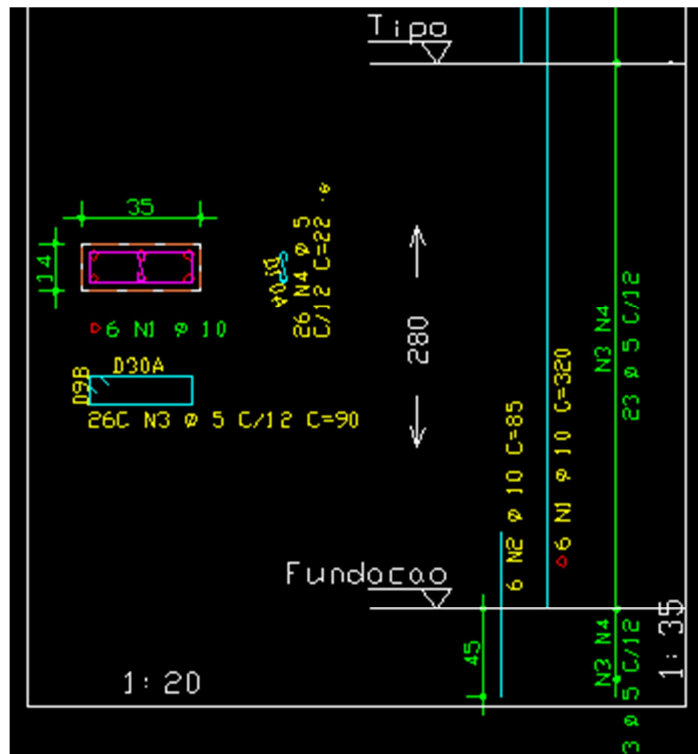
Detalhamento das armaduras de aço do Pilar 11 antes da aplicação do SISE.
